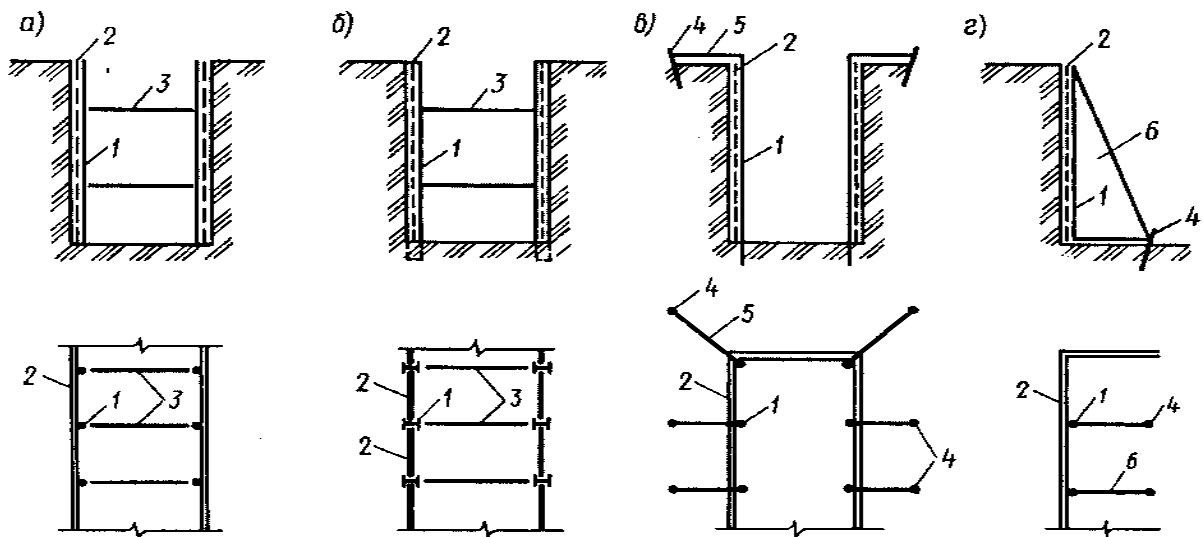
Кріплення вертикальних стінок виїмок:
